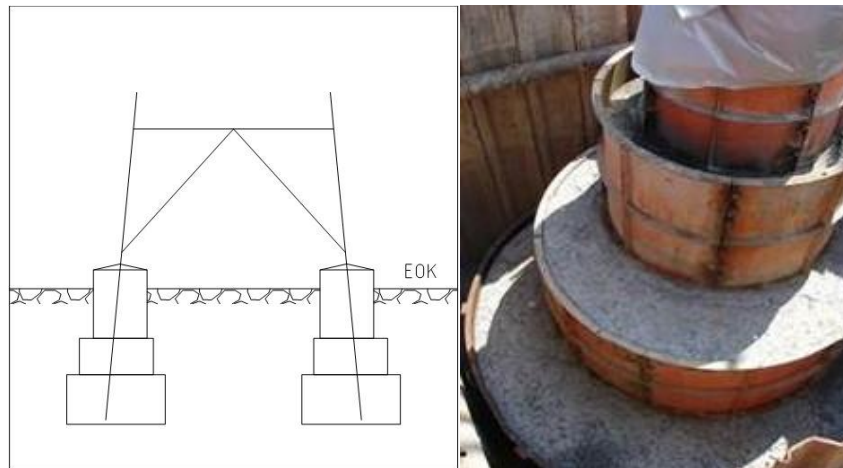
Stufenfundament - Prinzipzeichnung (l.) und Bauausführung (r.)
